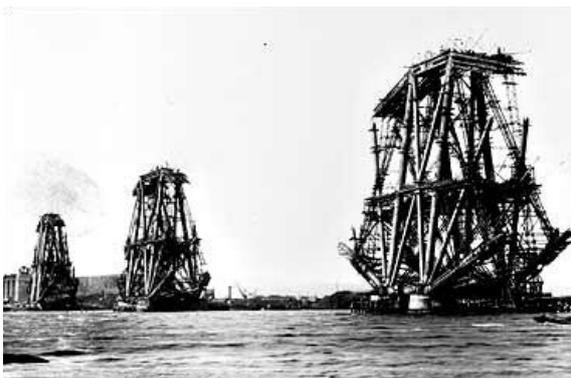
Ponte Firth of Forth em construção, Escócia. Projeto: John Fowler, Benjamin Baker. Fonte: http://www.pbs.org/wgbh/buildingbig/wonder/structure/firth_of_forth. Acesso agosto 2005.
